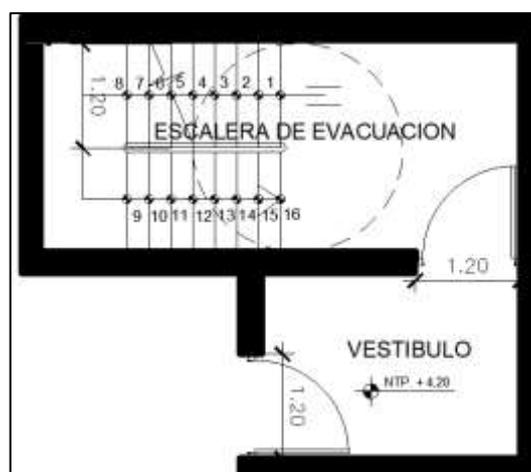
Planta segundo nivel del proyecto-cafetería- escalera de evacuación.
